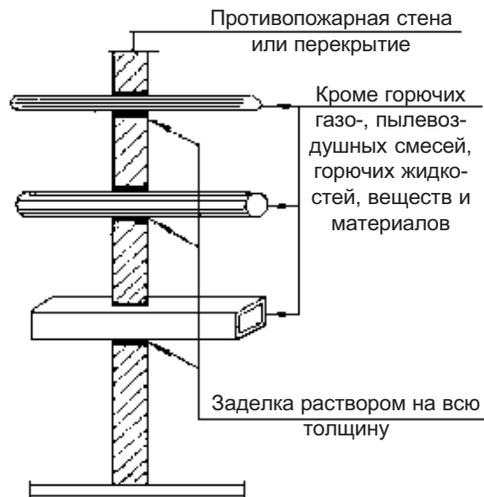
Пересечение противопожарных стен, зон и перекрытий 1-го типа каналами, шахтами, трубопроводами
